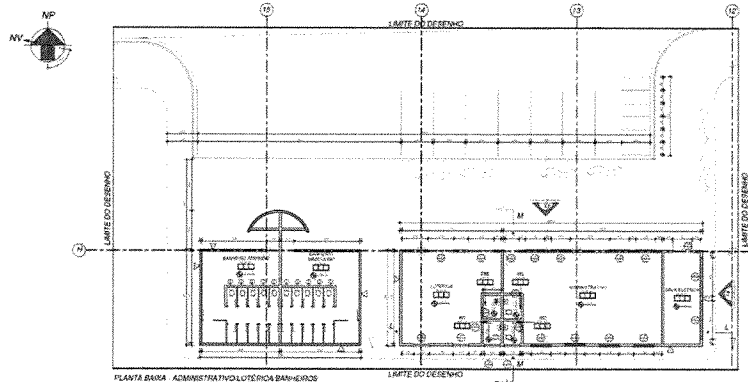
Administração/Lotérica/Banheiros - Planta Baixa
